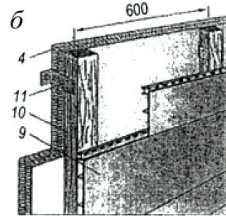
Утеплення стін за методом «Вентильований фасад»:
